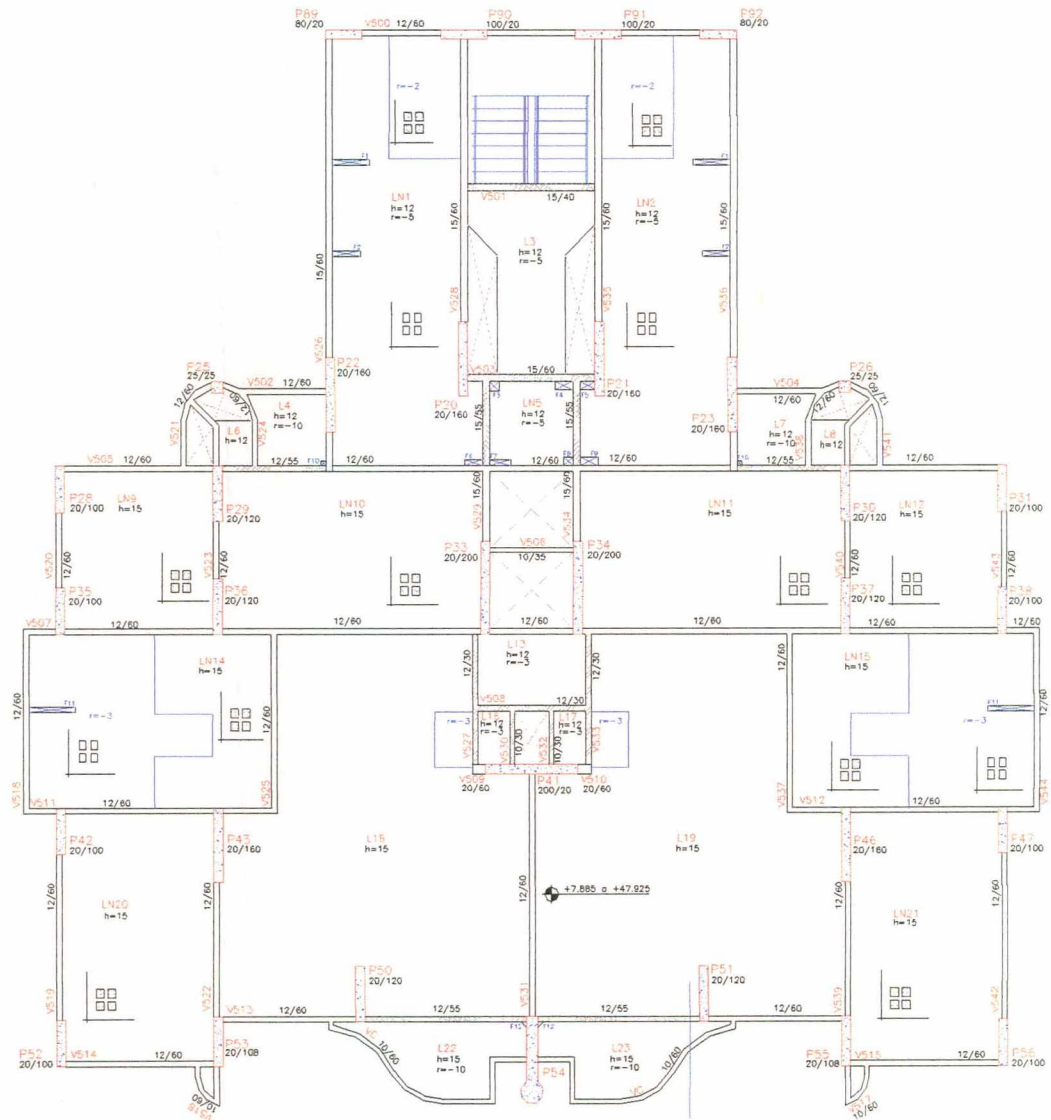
Planta de fôrma do edifício 16ENT1
